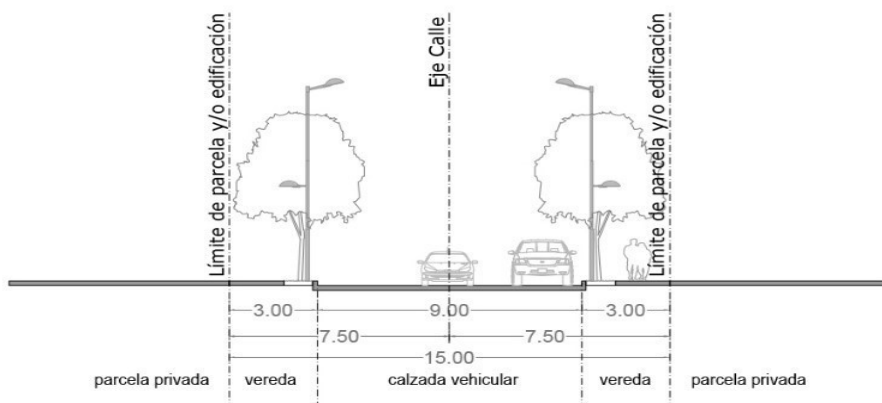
Sección transversal de Vías Calles Tipo 9.
